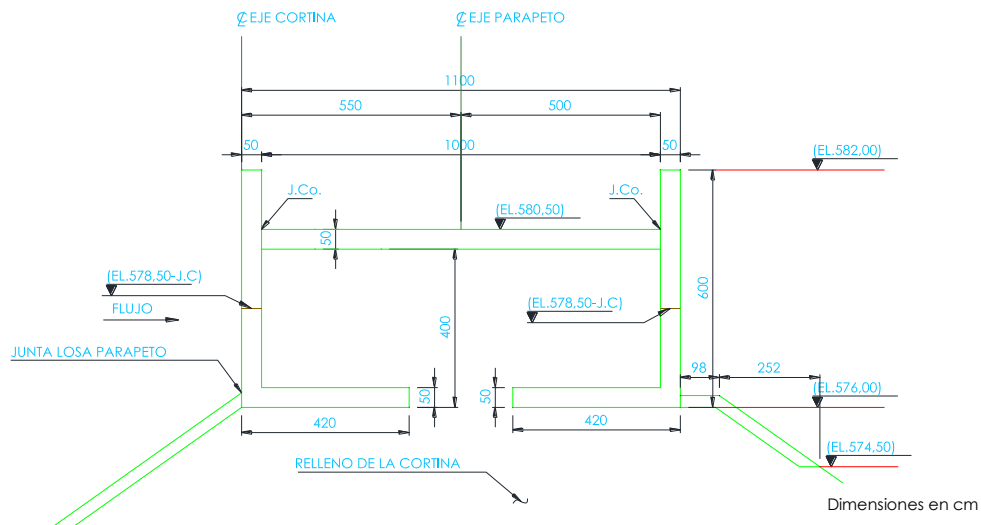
Sección Transversal Muros de Parapeto en la sección máxima de la Presa La Yesca
